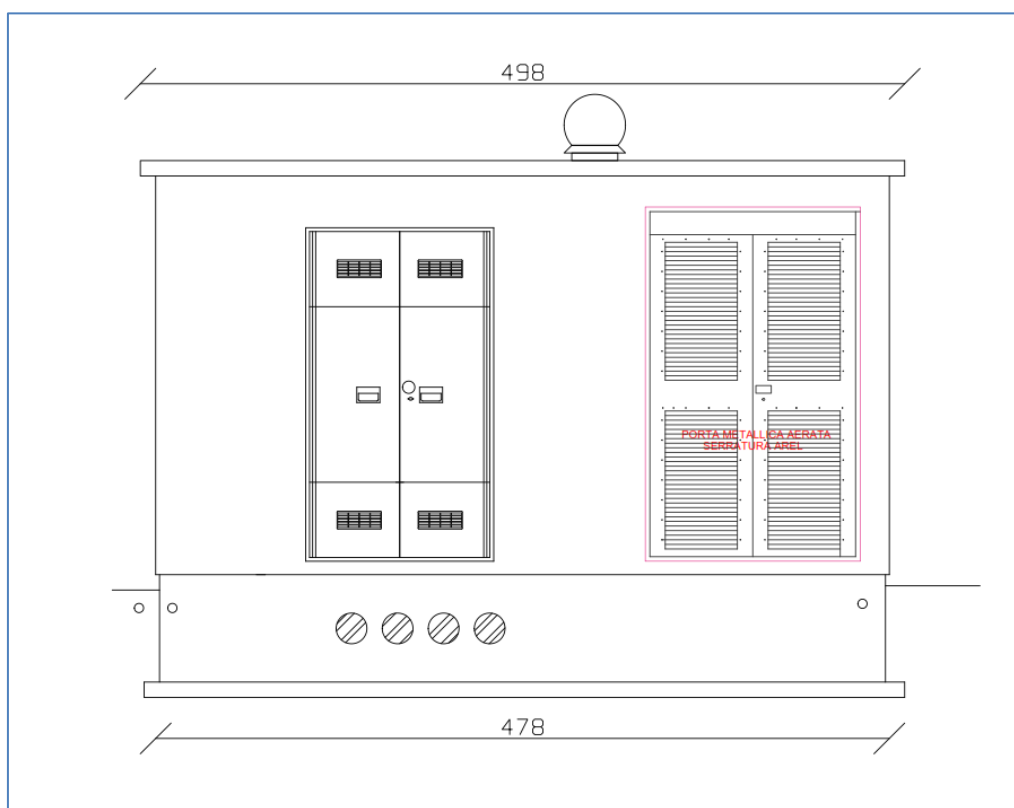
Prospetto tipo della cabina di trasformazione posizionata su vasca di fondazione
